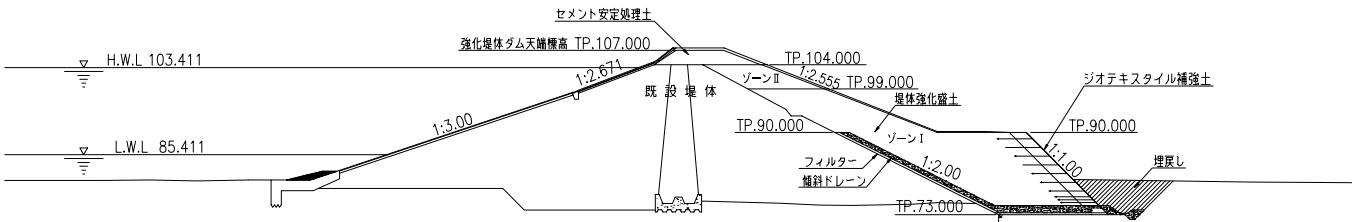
村山下貯水池堤体強化工事計画断面図（河床部標準断面図）
